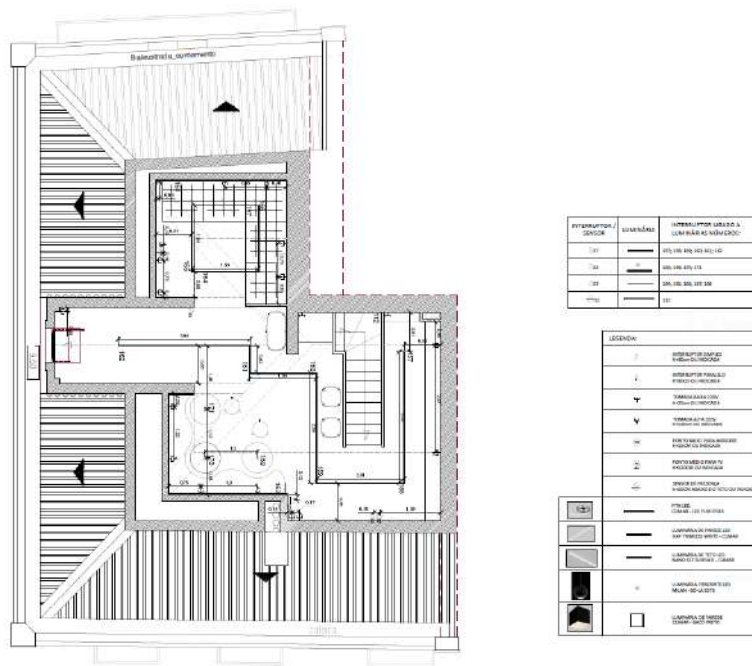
Planta de Iluminação e Tomadas - Piso das Águas-Furtadas
